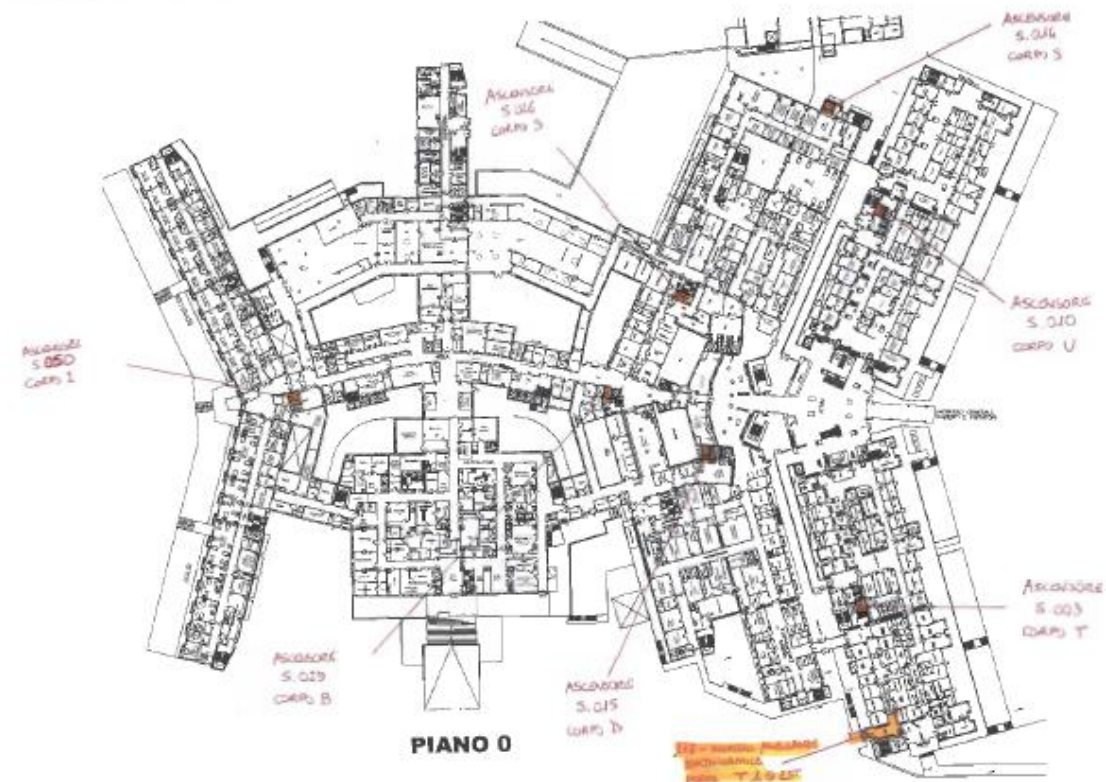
Planimetria del piano "0" dell'Azienda Ospedaliera di Ancona
